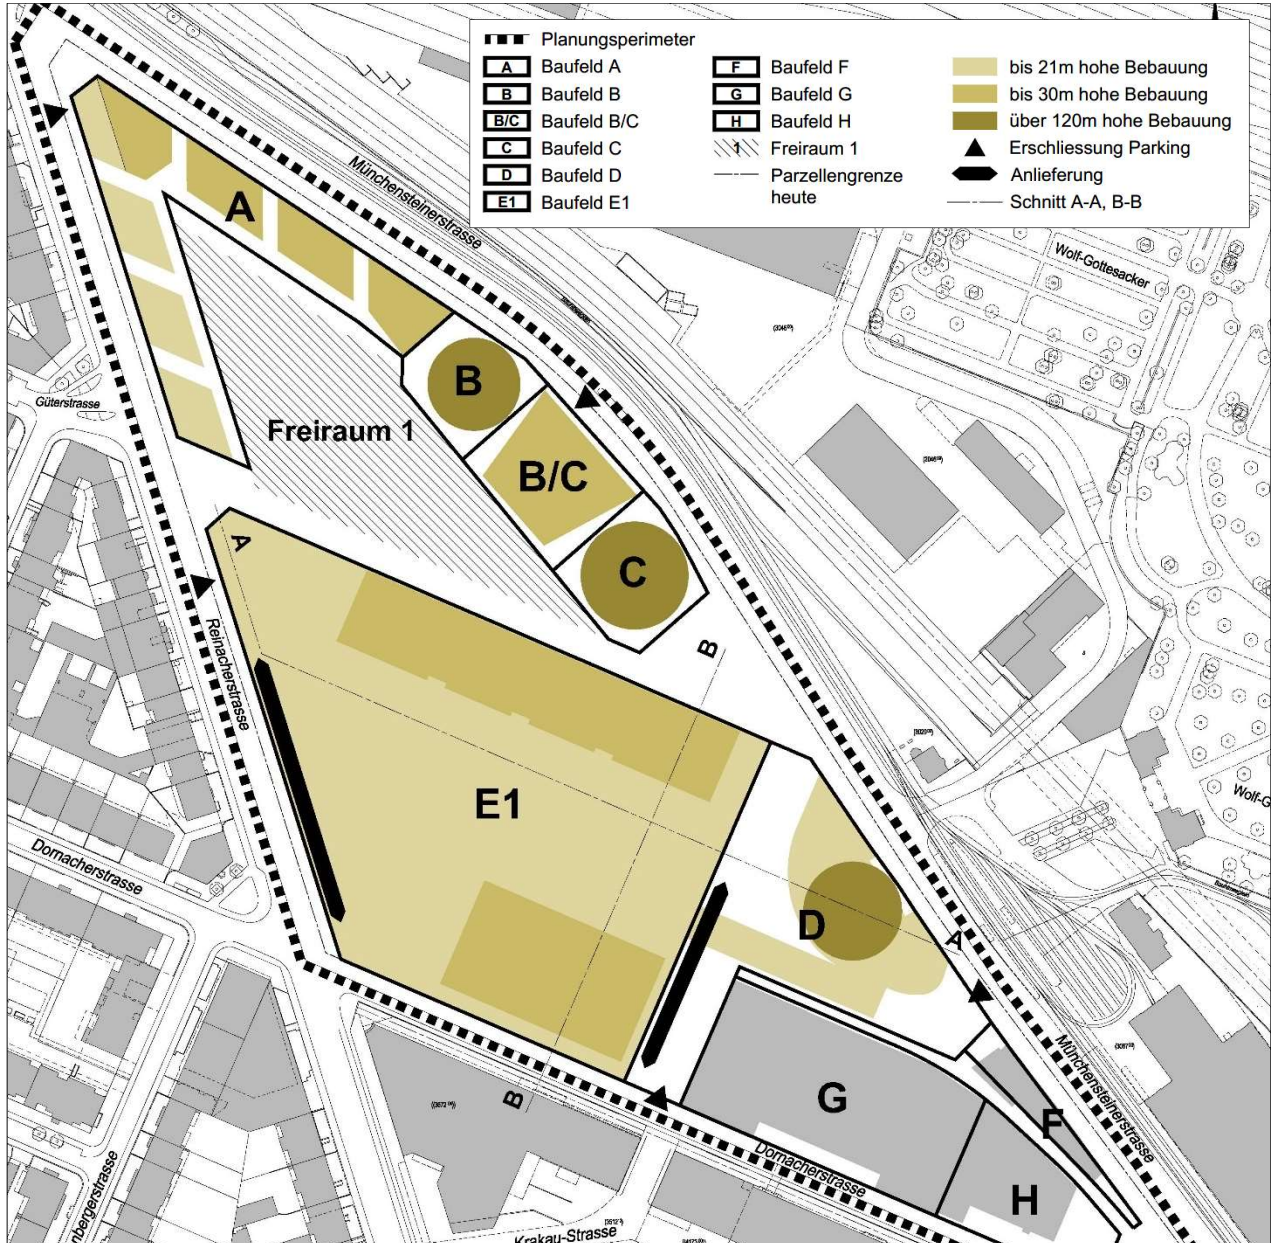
Bebauungsplan Erdgeschoss, Situation. (Kein Massstab, Plan genordet)
